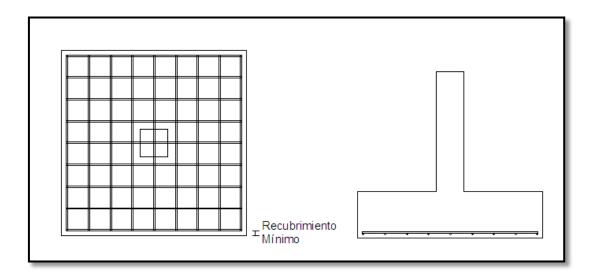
Esquema Tipo de Distribucion de Armaduras de Zapatas
